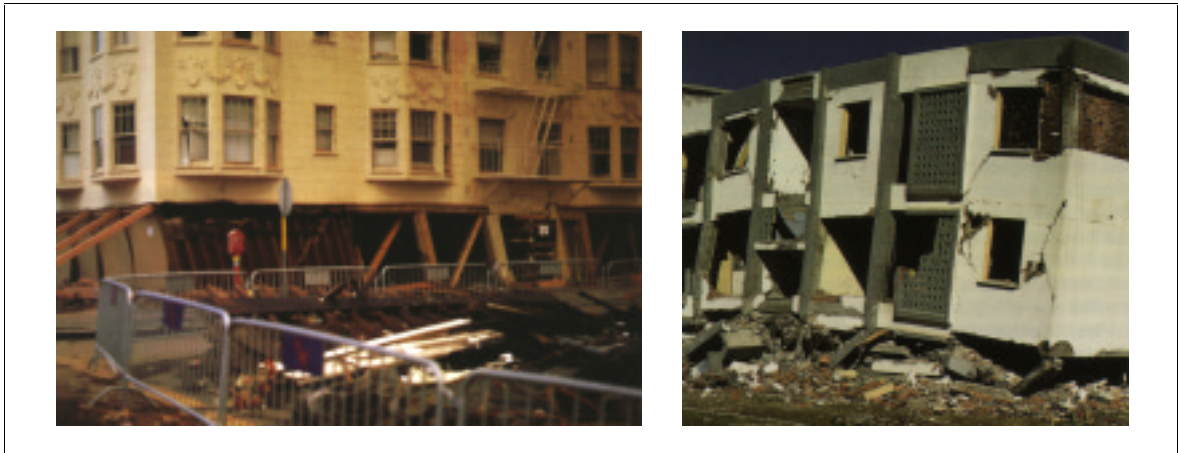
Schichtung im Erdgeschoß: San Francisco, Holzskelettbau, Erdbeben 1989, [Münchener Rück, Seite 22, 1994] und Stahlbetonskelettbau, El Asnam, Algerien, Erdbeben 1980 [Tiedemann, Seite 485, 1992]
